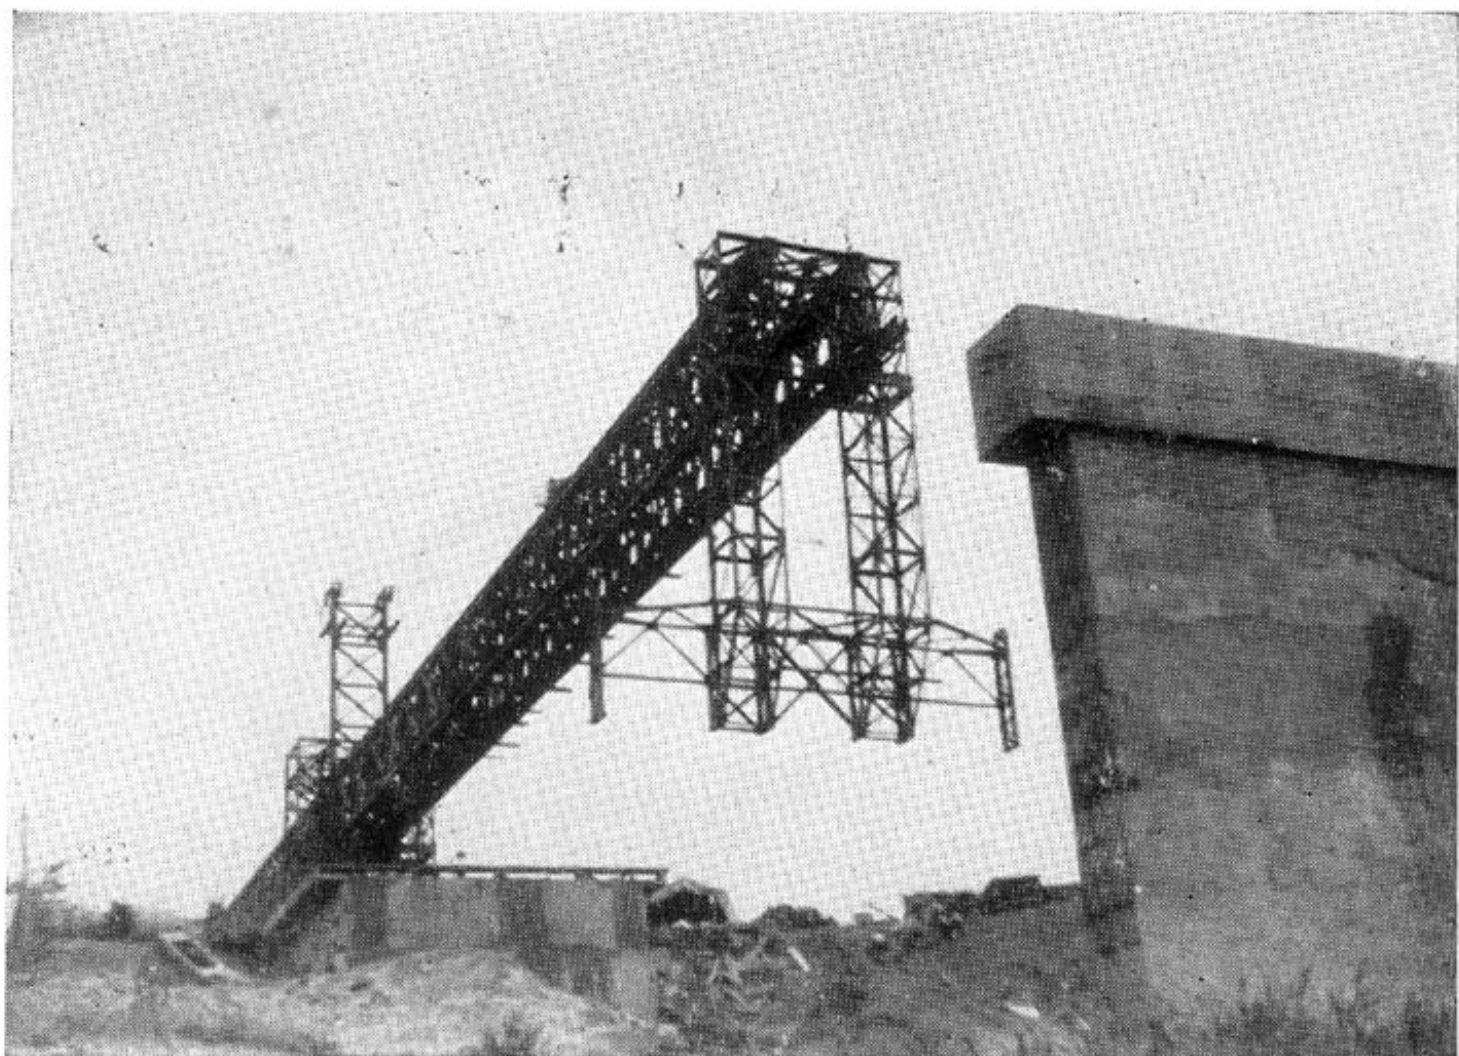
Dormentes e trilhos para a movimentação da treliça
